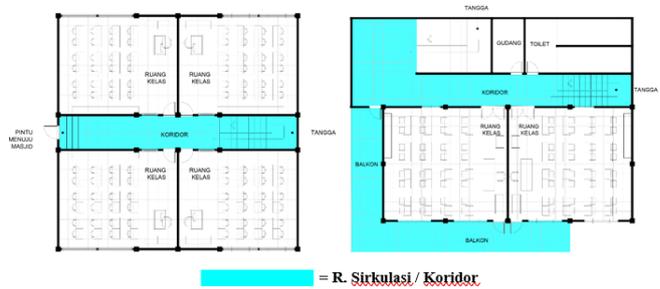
Ruang Kelas Masa 1 (kiri) dan Ruang Kelas Masa 2 (kanan)
